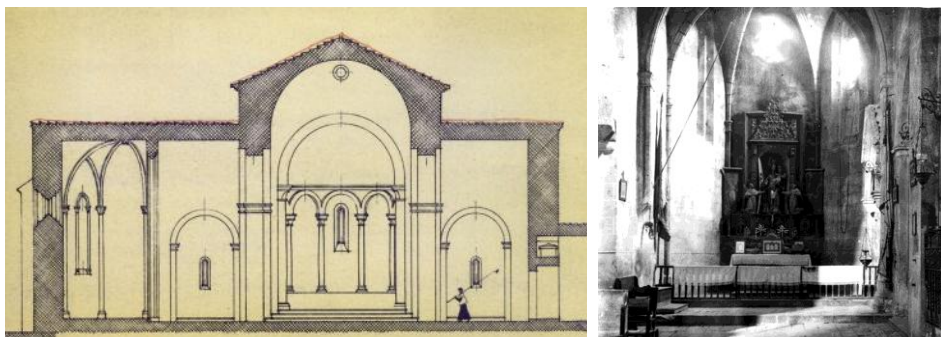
Vilabertran. Monasterio de Santa María AAFV. Sección longitudinal. Plano de proyecto. A. Ferrant
